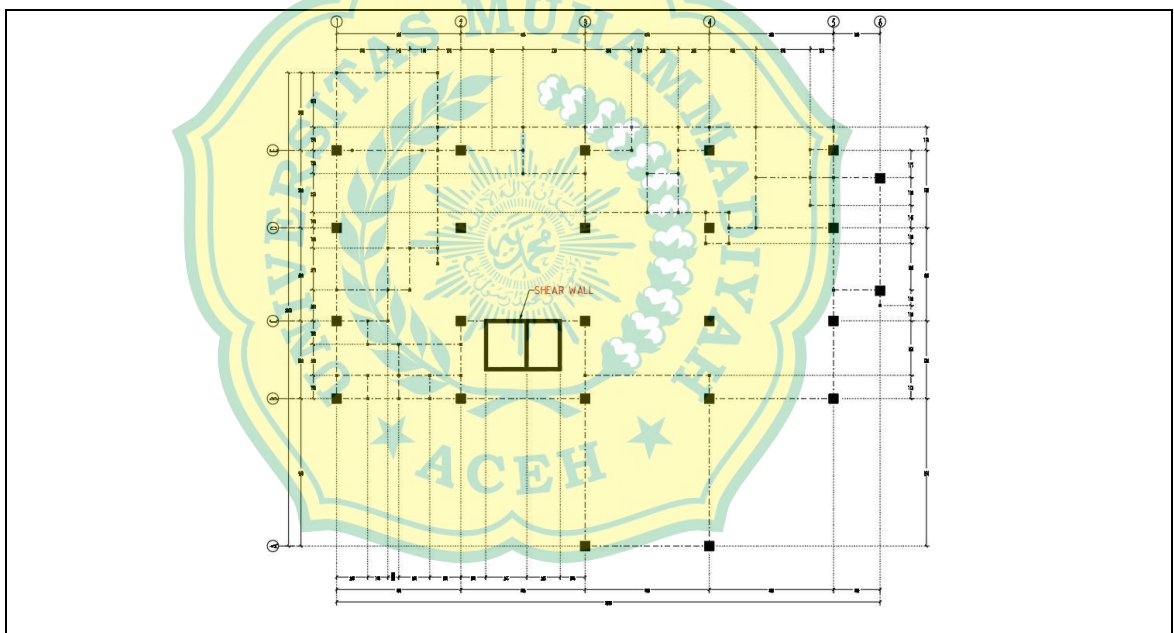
Denah lantai 1, lantai 2, lantai 3, lantai 4 dan Rooftop
